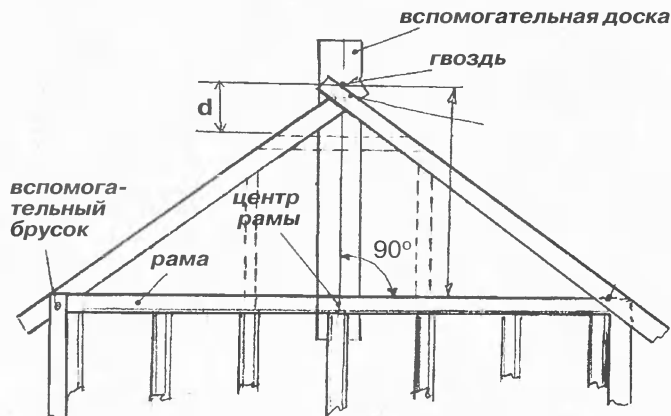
Разметка стропил для крепления конькового бруса, где d — диаметр.
